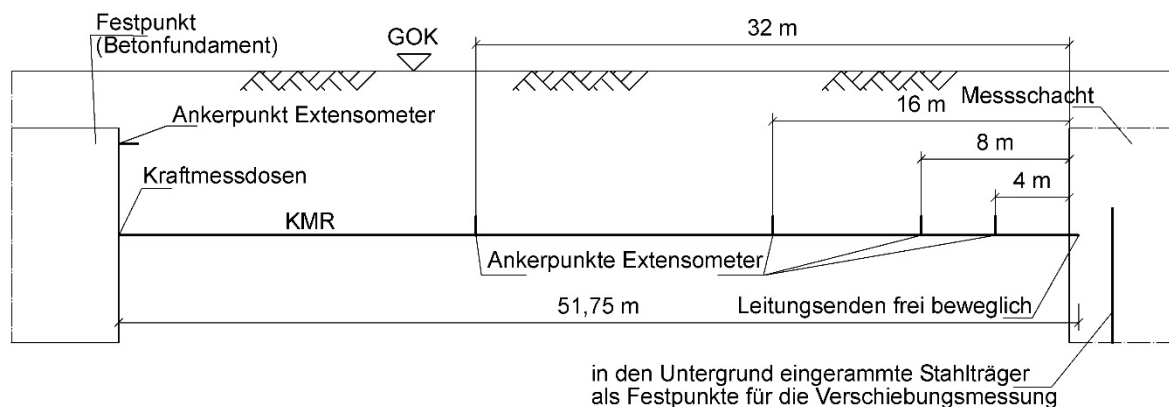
Schematischer Längsschnitt der Messstrecke „Bypassleitung“ mit Lage der Extensometer
